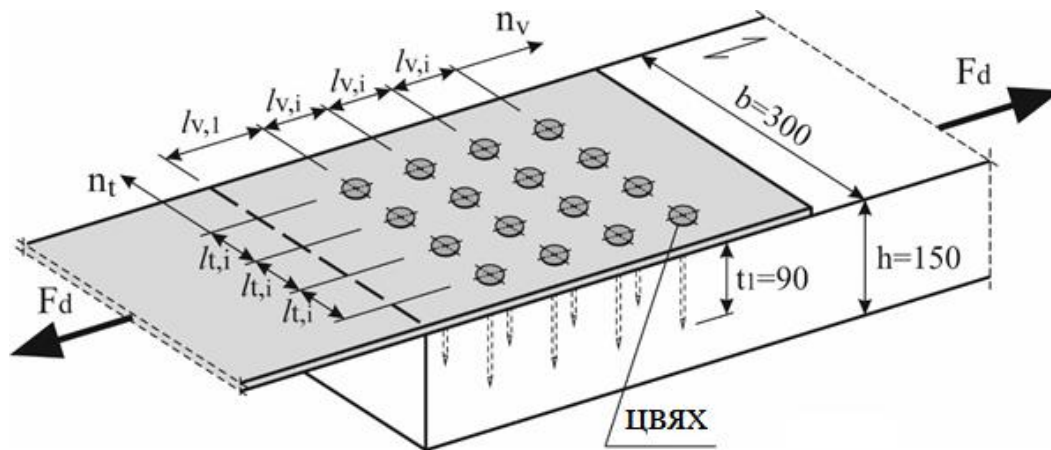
Цвяхове з'єднання з металевою пластиною
